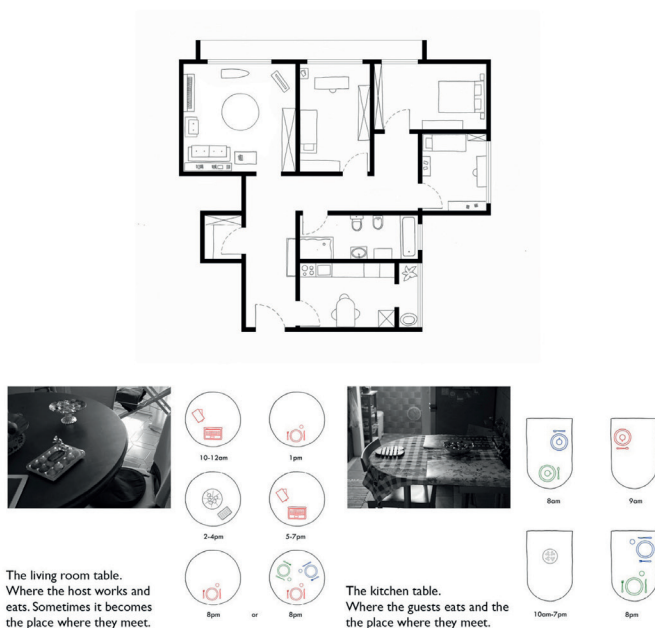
La planimetria di una delle case osservate e il dettaglio sull'uso dei tavoli (Fonte: J. Abouelezz, E. Alberton, B.E. Alfar, A. Beni, R. Piantelli).
